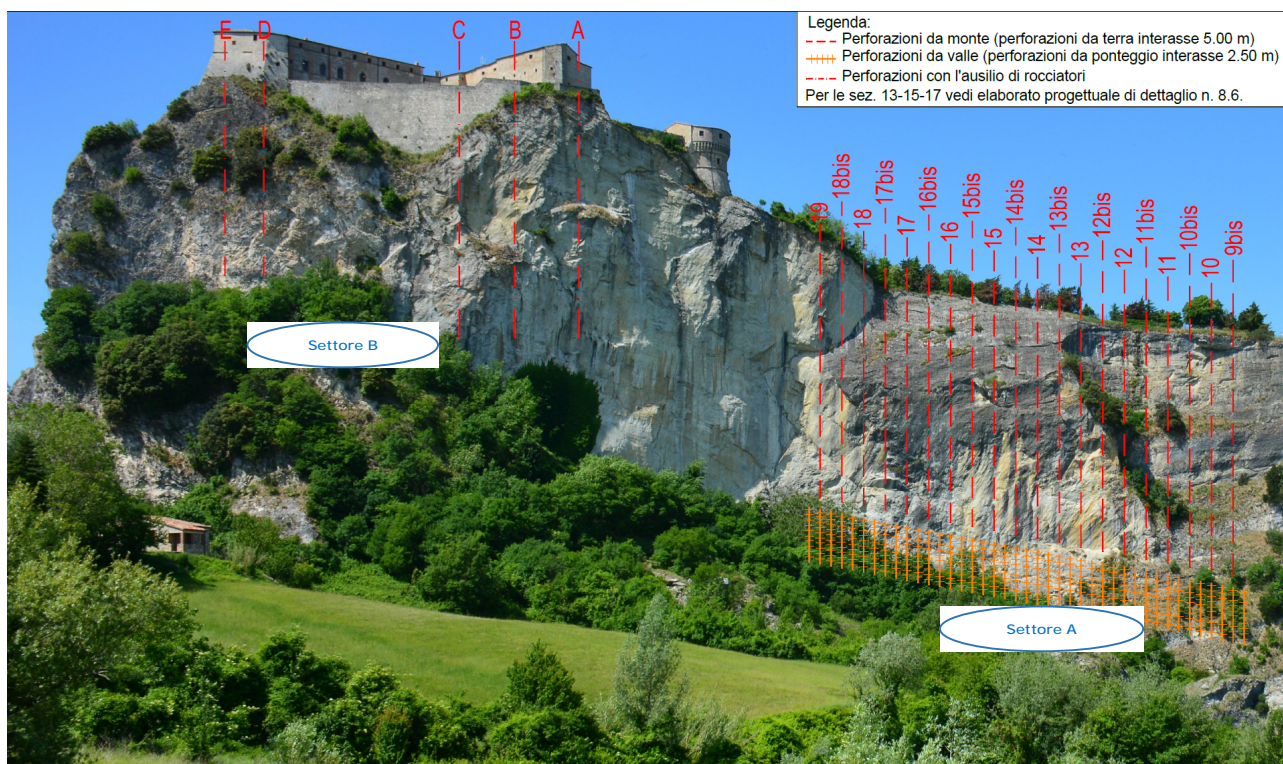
Stralcio elaborato 08.7 con indicazione prospettica delle aree interessate dagli interventi di consolidamento con ancoraggi passivi (barre in perforazioni)
